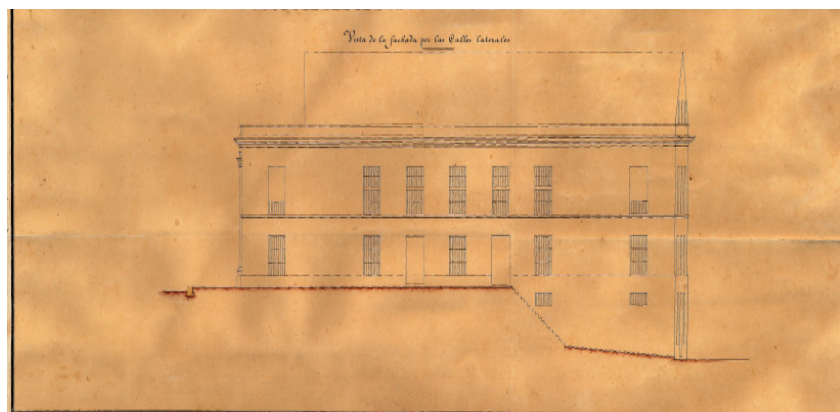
Detalle vista lateral (AHMM, Cuba 257-01).
